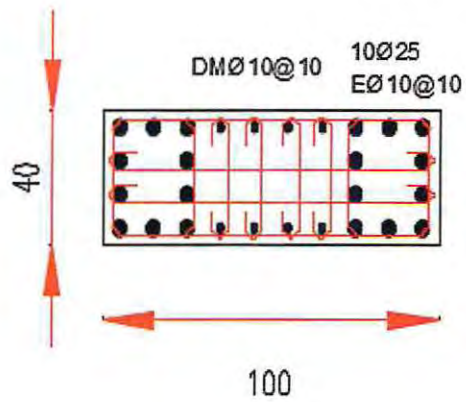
Disposición armadura Ed. Tradicional muro "RP".
